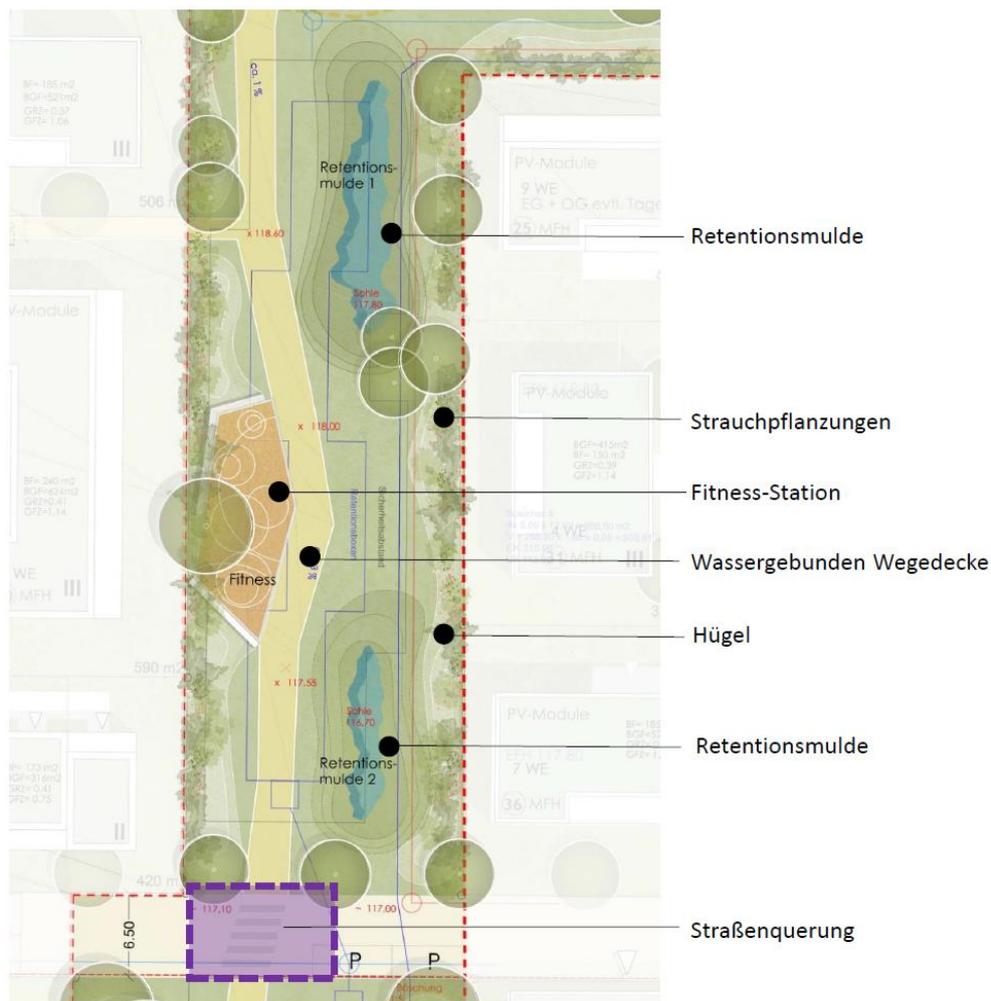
Auszug aus dem landschaftsplanerischen Konzept mit randlichen Strauch- und Baumpflanzungen
